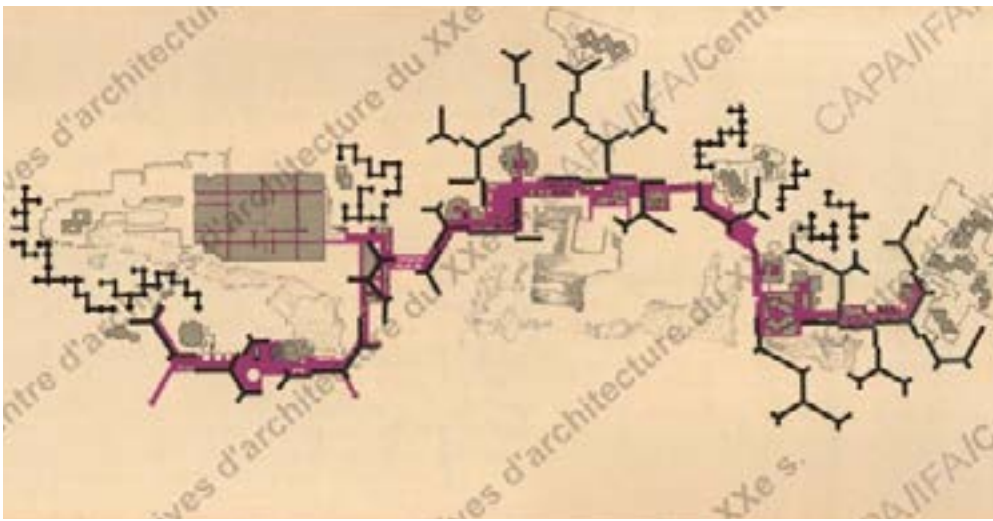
Fond Candilis, cité de l'architecture et du patrimoine, 1961-1981. ZUP du Mirail, Toulouse (Avec A. Josic et S. Woods) : plan de masse
